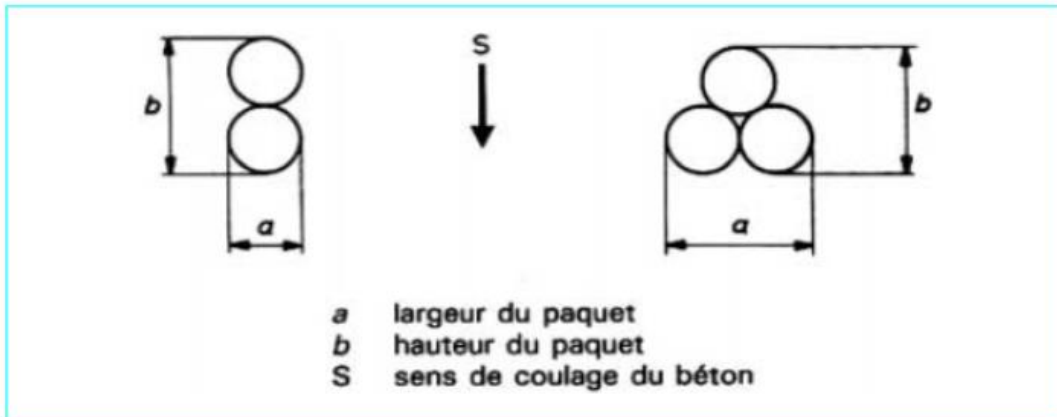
Dispositions des paquets de 2 ou 3 barres
